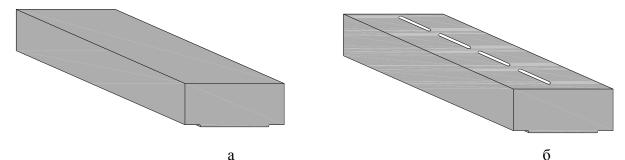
Внешний вид изделия: а) крышка; б) решетка
